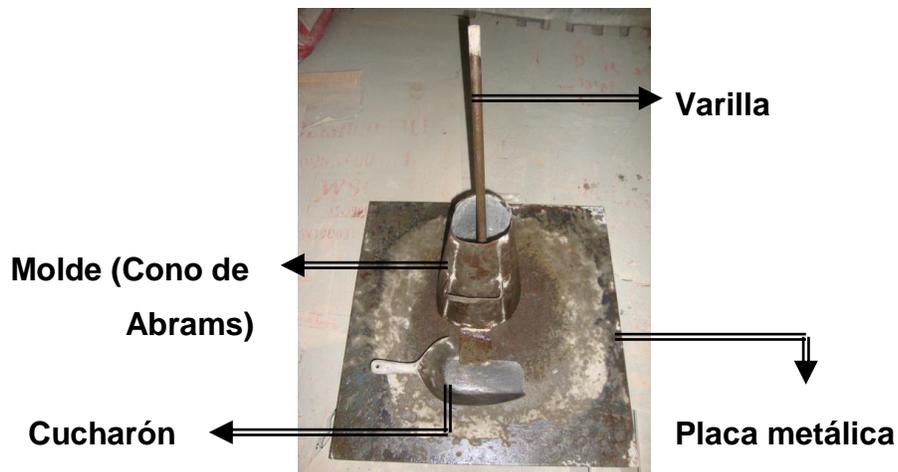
Equipo de ensayo de asentamiento¹⁵
